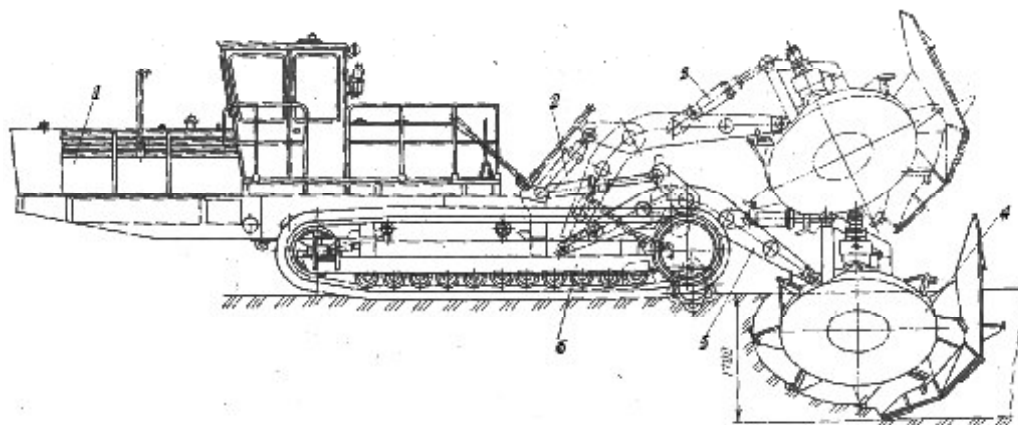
Конструктивная схема экскаватора-каналокопателя ЭТР-172
